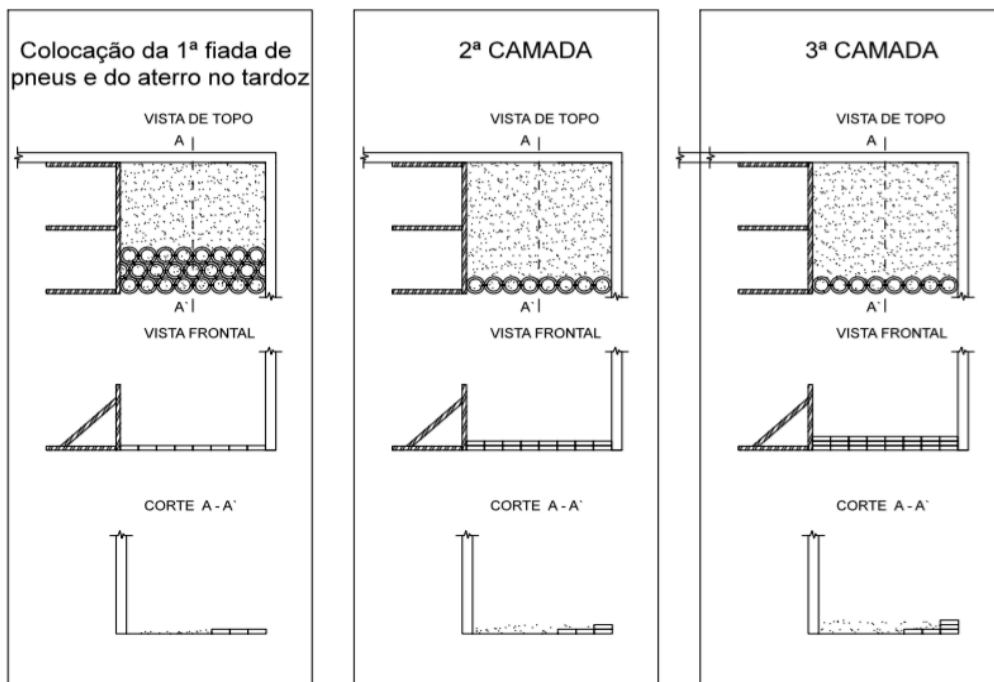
Faseamento construtivo da 1ª à 3ª camada.
